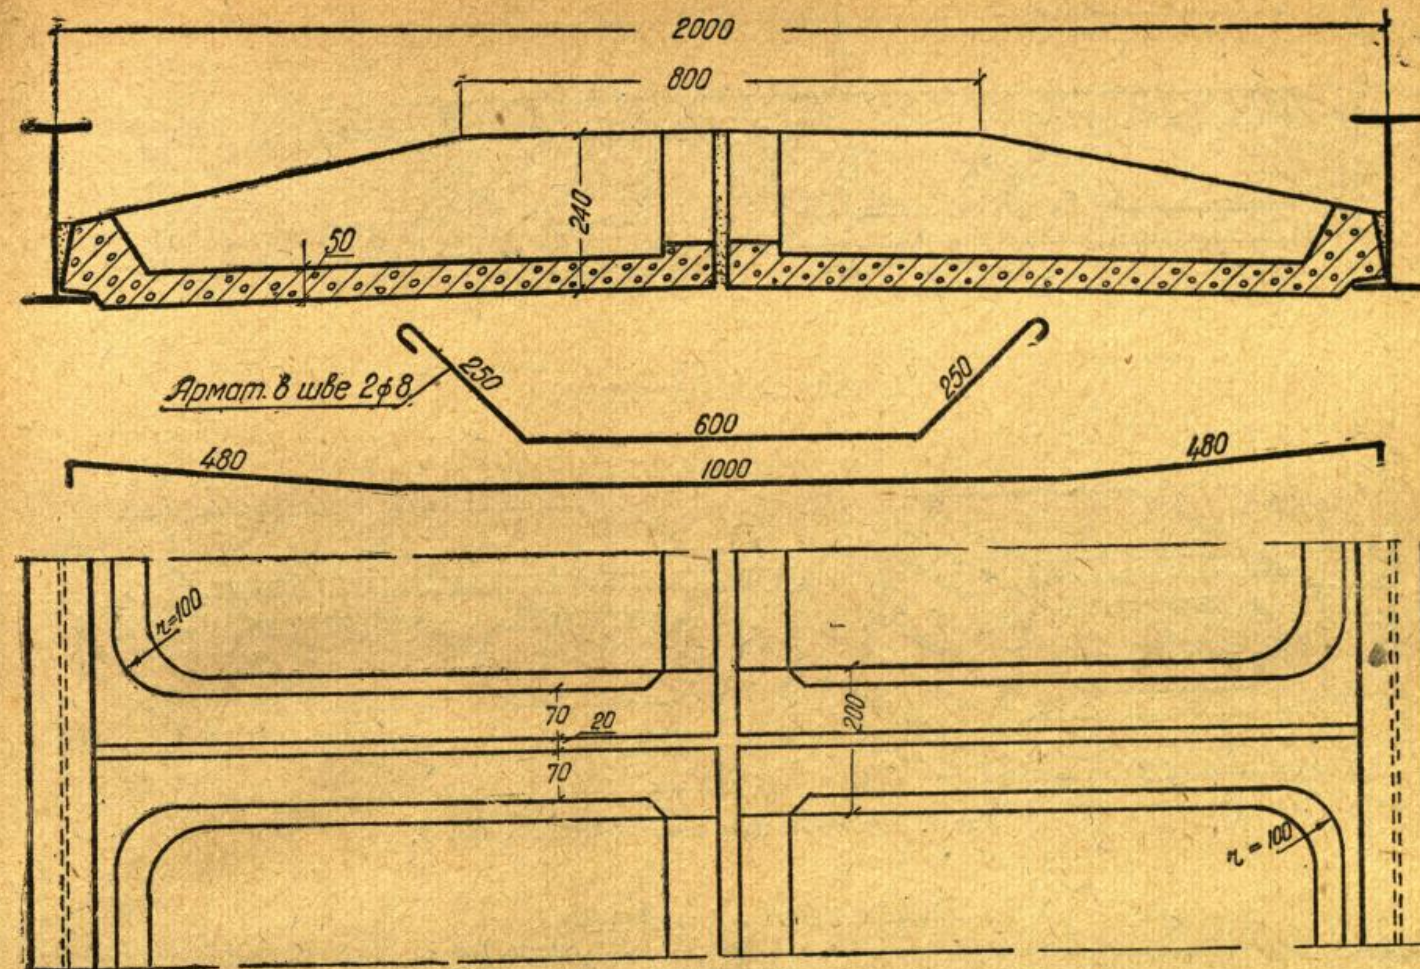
Междуетажное перекрытие с нижними шлакозольными бетонными плитами.
